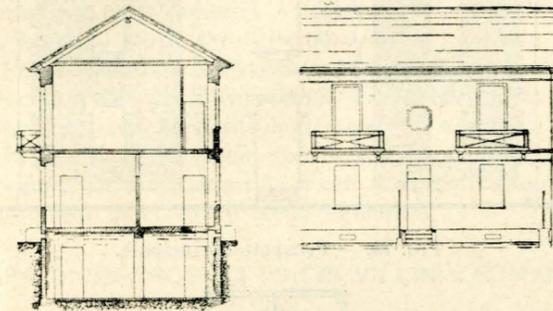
Sezione trasversale. FIG. 11. — Facciata.
